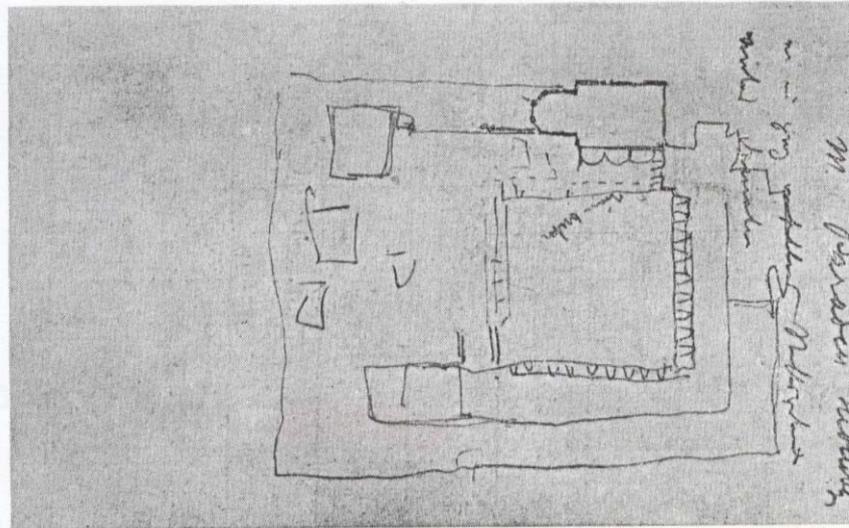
Karl Haas, Grundriss des ehemaligen Klarissenklosters, 1856
